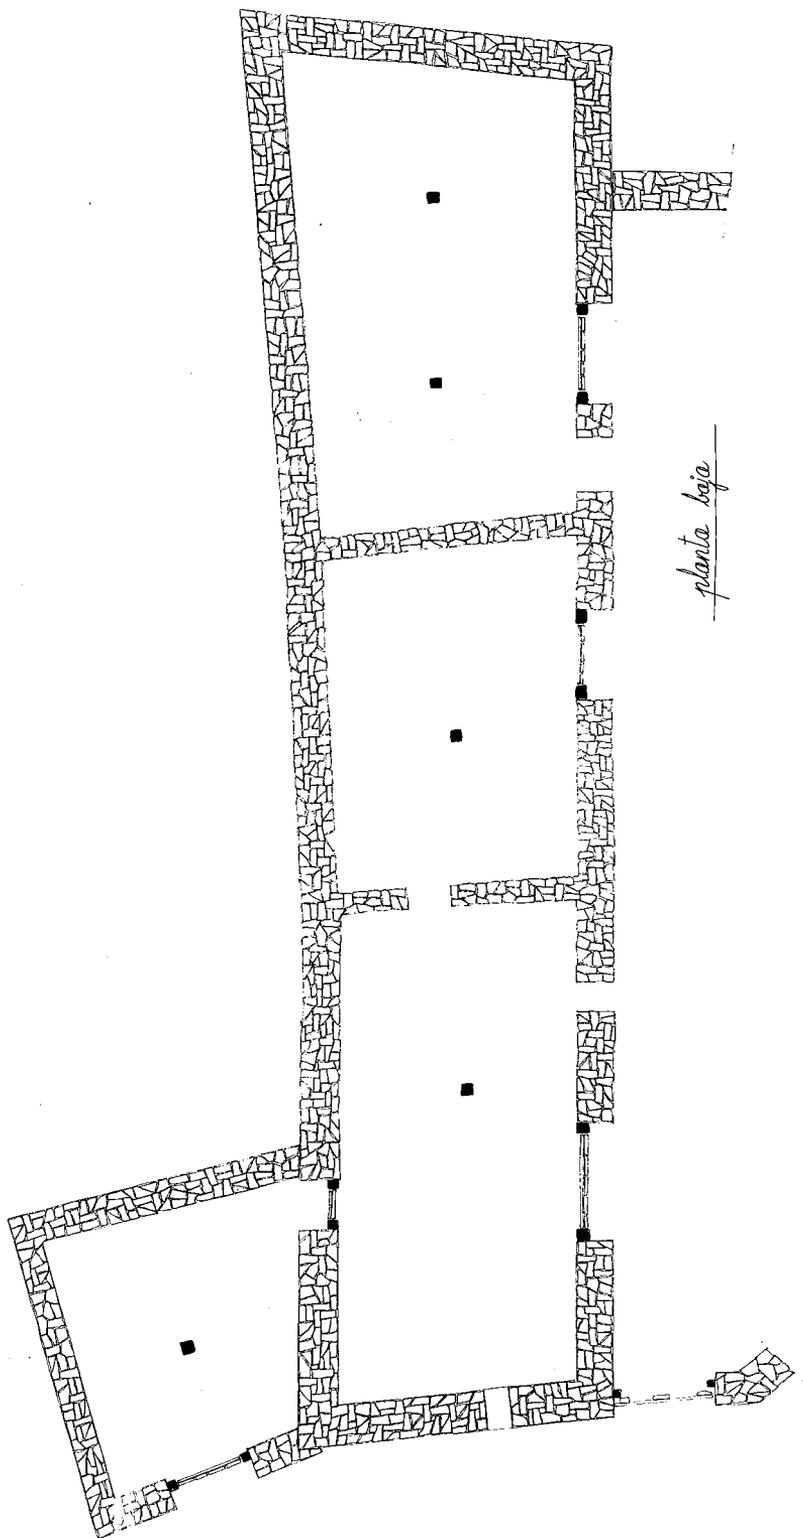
Matallana III. Casilla 4. Planta baja.
